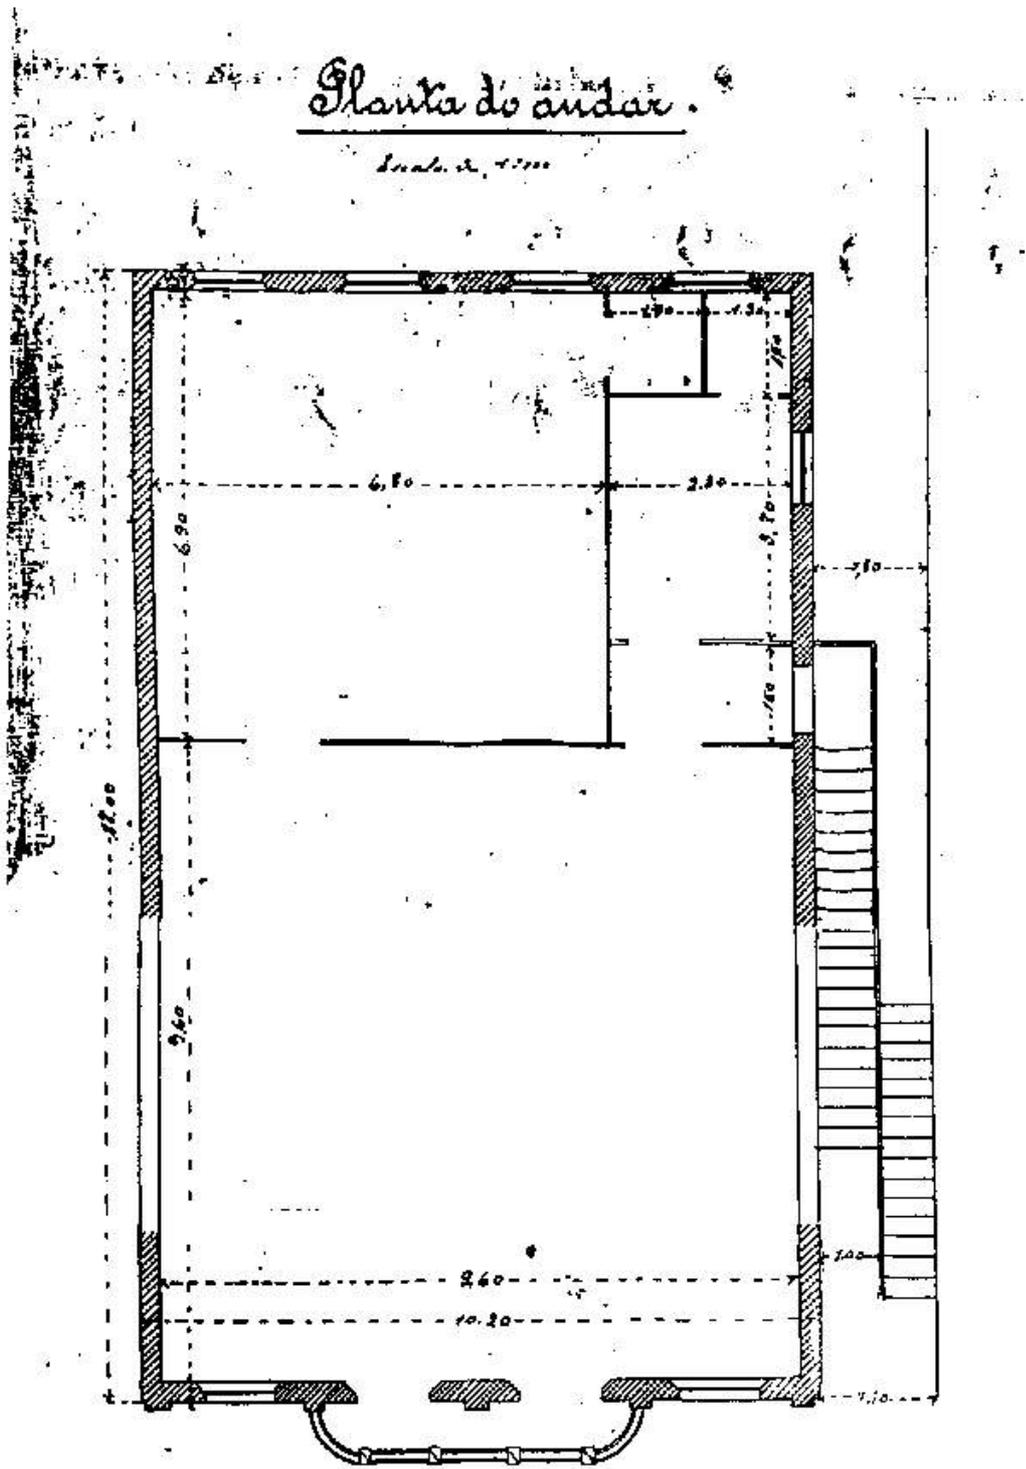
Planta do 2º. pavimento da Societá (projeto)
